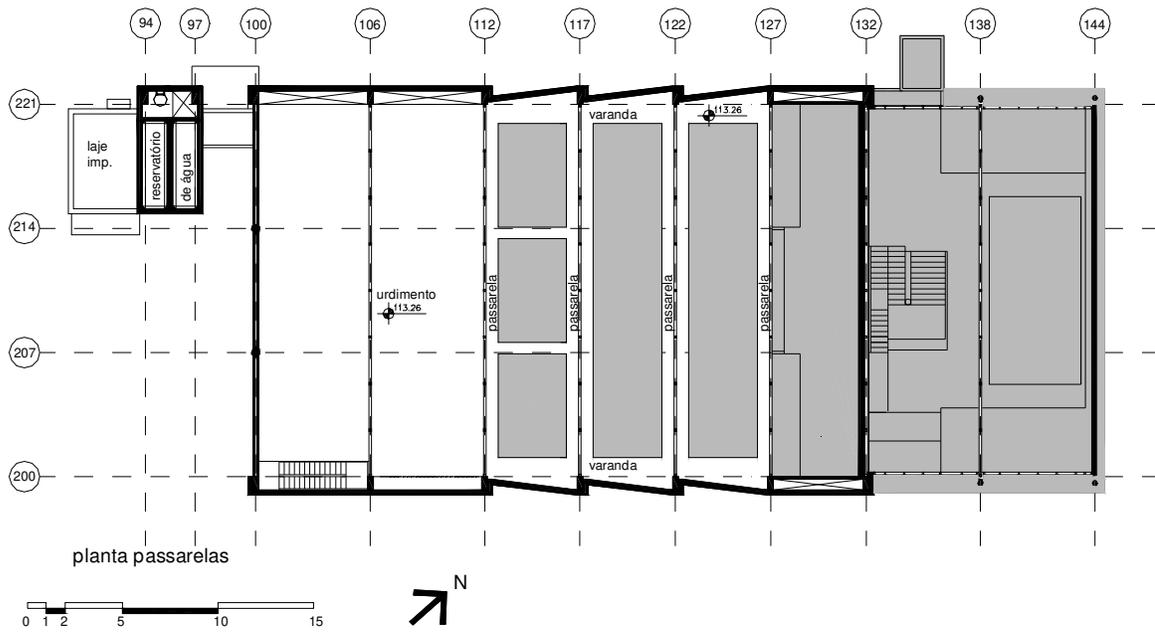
Planta das passarelas técnicas – Teatro Santa Cruz
